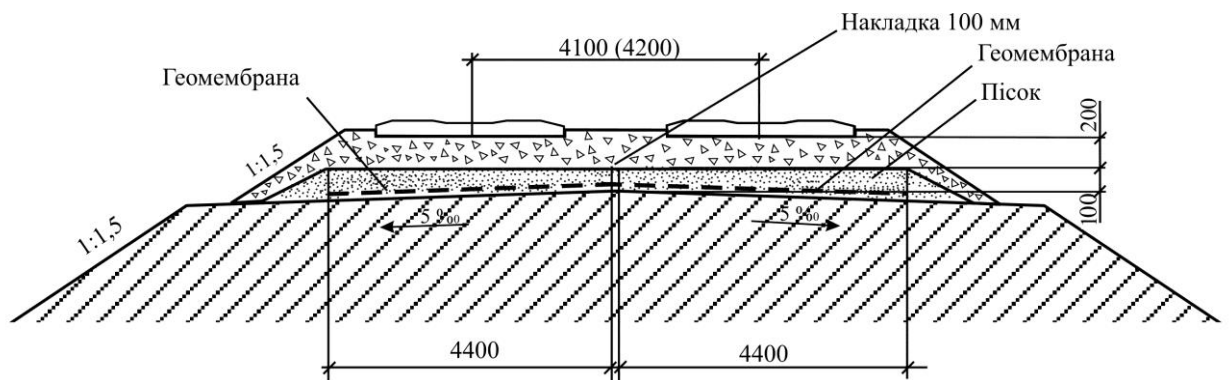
Конструкція земляного полотна із геомембраною
